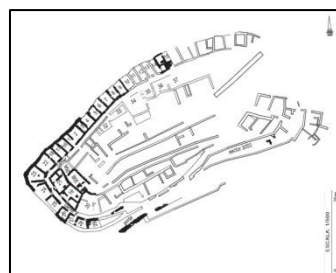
Planta de Puig Castellet (Lloret de Mar)
